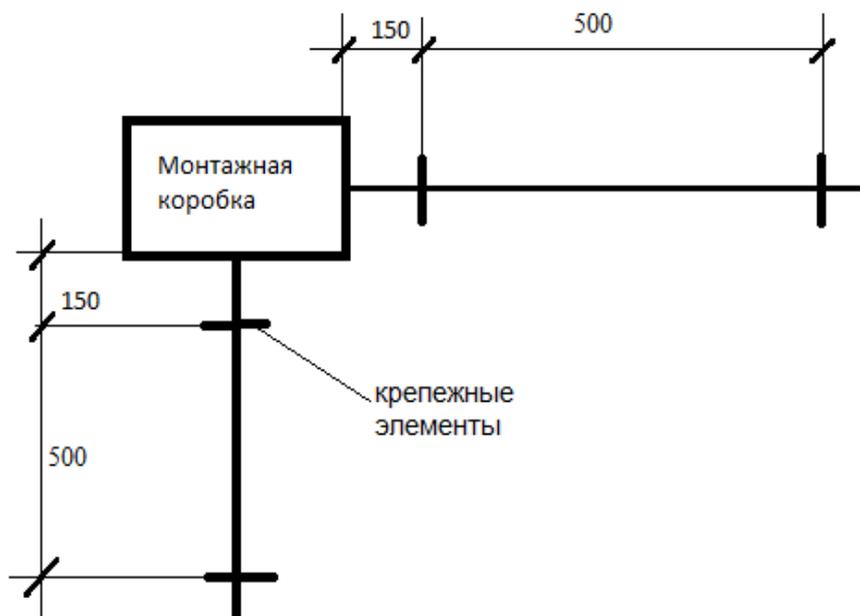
Схема крепления гофрированного металлорукава к несущей конструкции.
